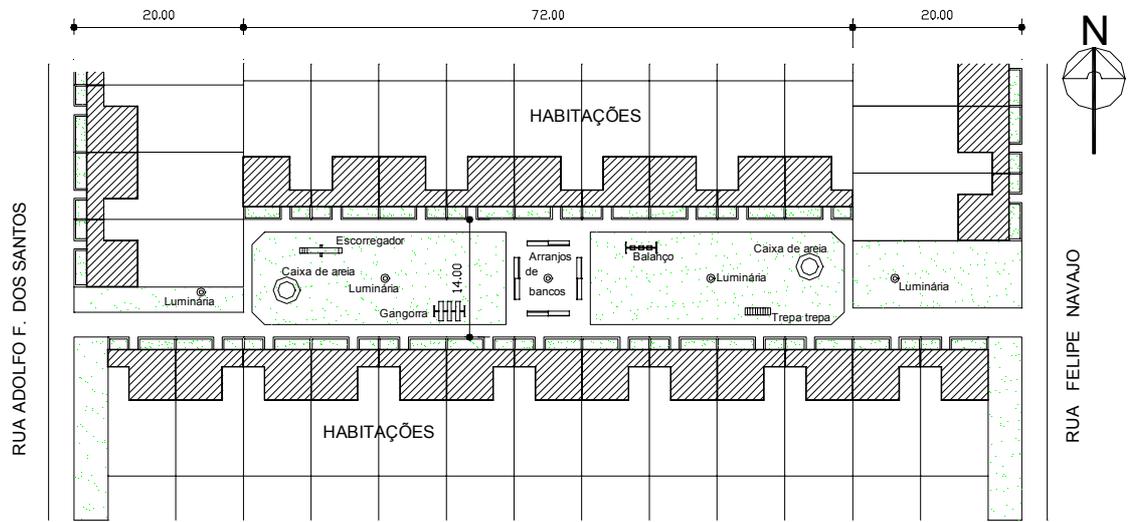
Planta Original do Espaço Aberto Comum 4 do CHST
